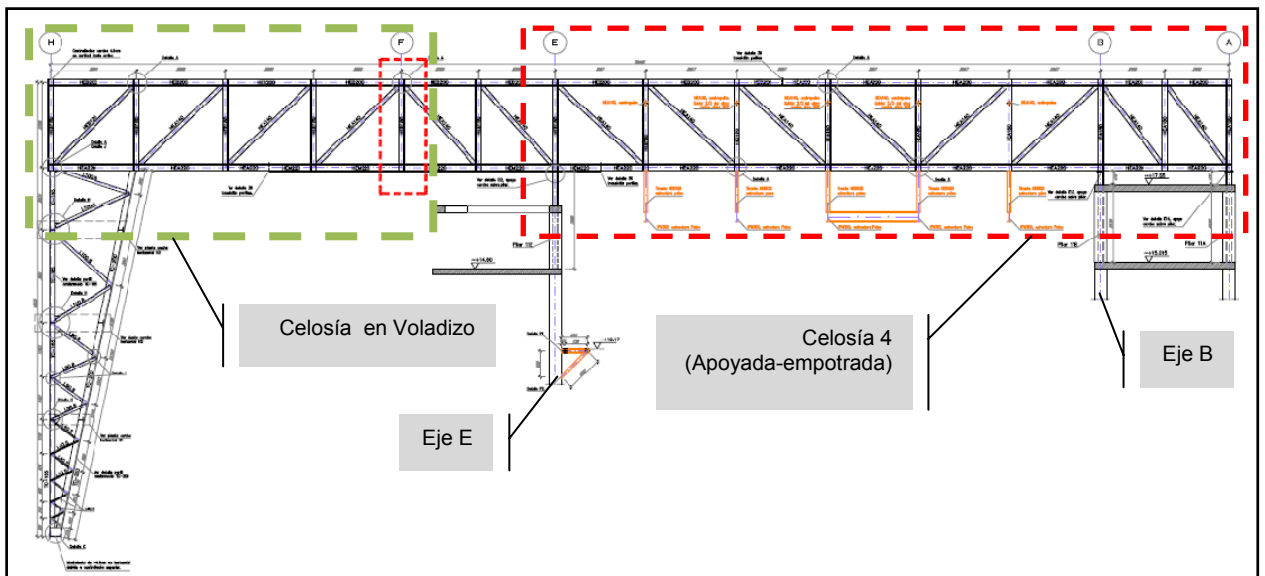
Alzado del eje 11. Celosía Apoyada-empotrada con voladizo.
